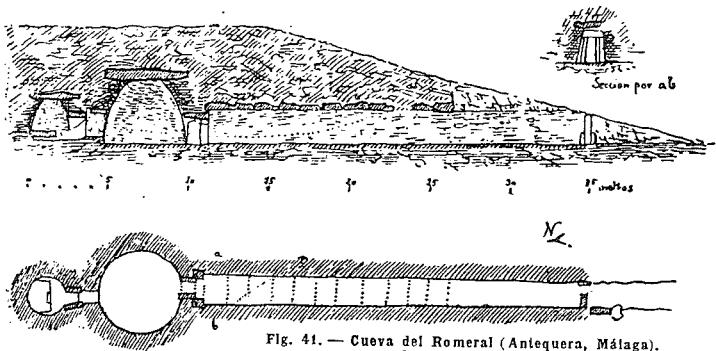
Cueva del Romeral (Antequera, Málaga). Sección y planta
